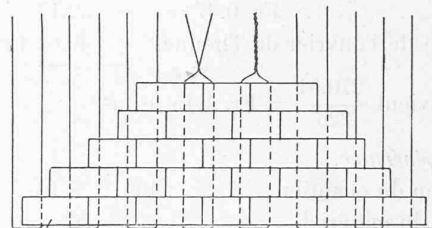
Disposition des étriers en fil N° 20 (4,4 mm.) assemblant la cuirasse de faible hauteur.
